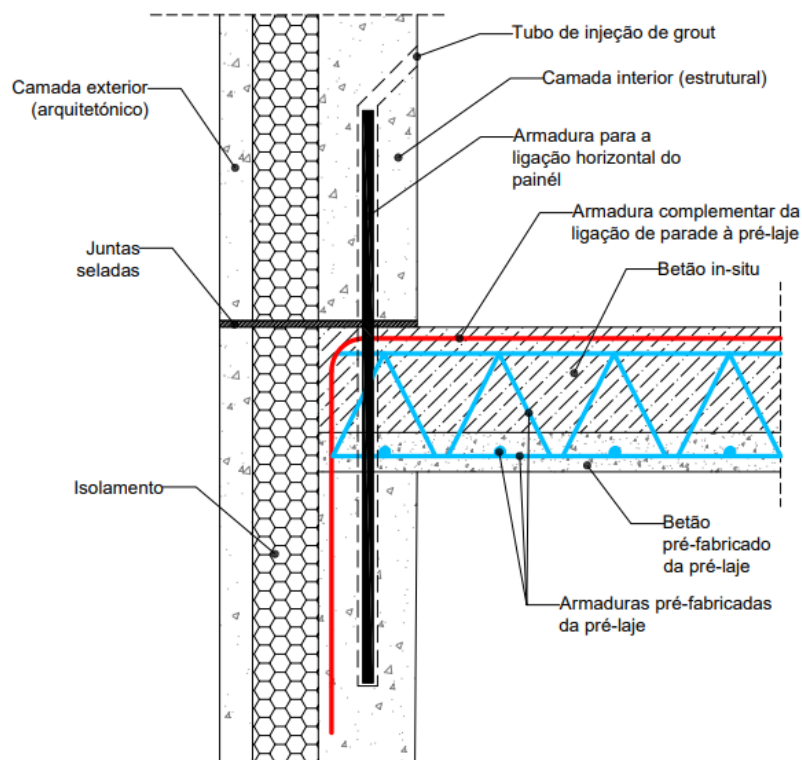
Ligação horizontal do painel sandwich e da pré-laje
